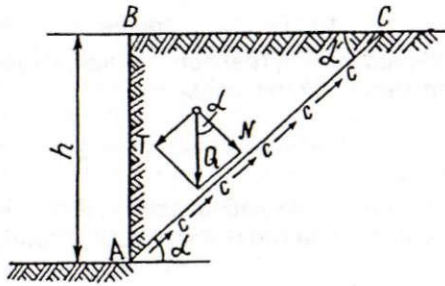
Схема к расчету устойчивости откоса идеально связного грунта
